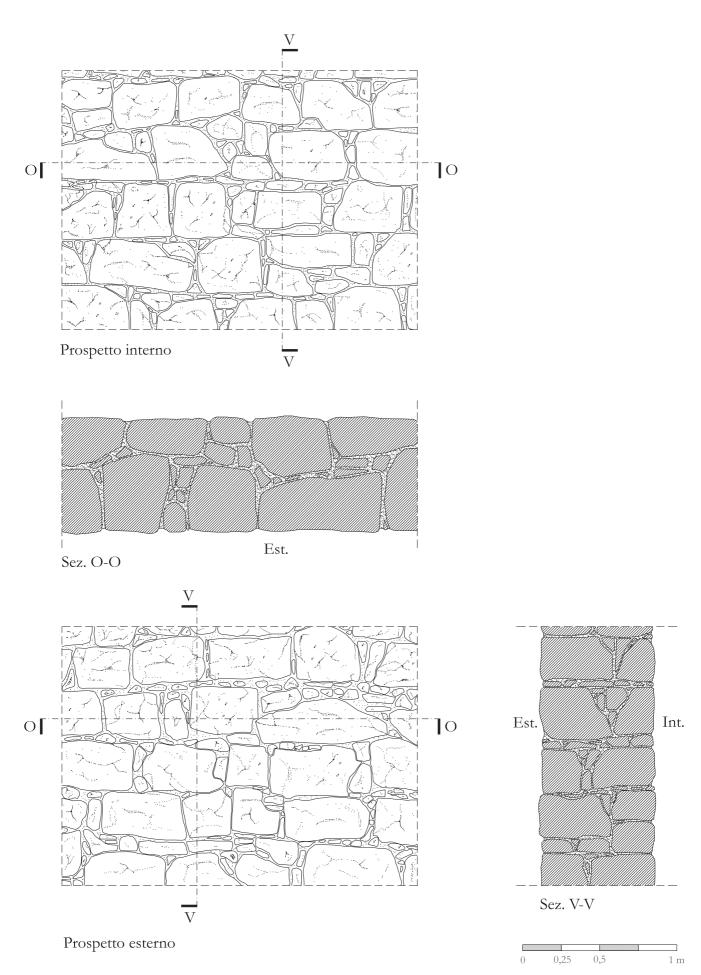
Dettaglio dell'apparecchiatura muraria in prospetto e sezione.
